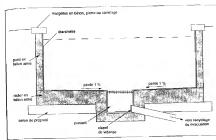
• Coupe transversale sur un bassin en béton armé.
